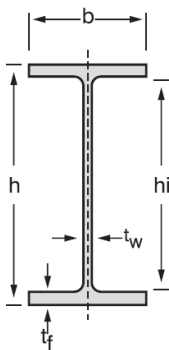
Perfil para utilizar, Aceros Ocotlán, Vigas IPR, www.acerosocotlan.mx.
